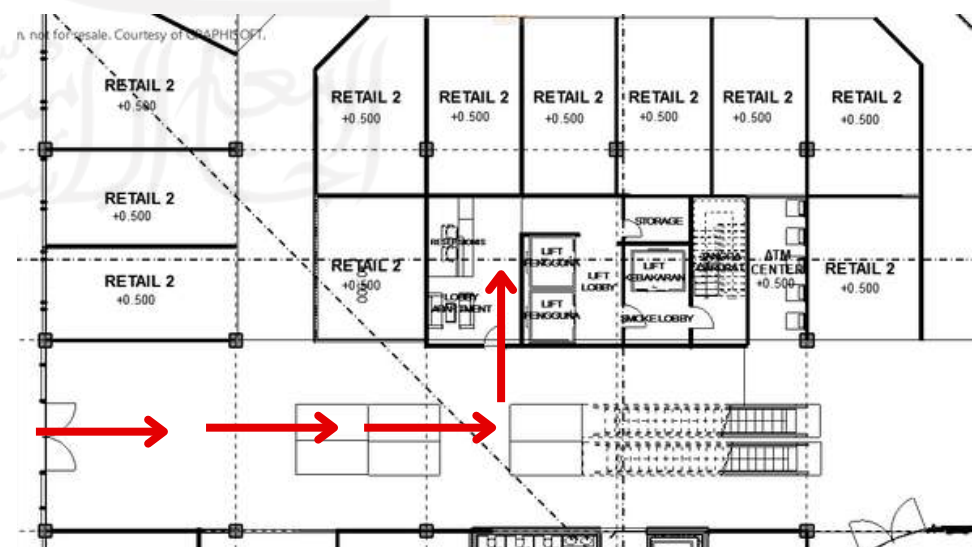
Denah lantai 2 sesudah perbaikan
